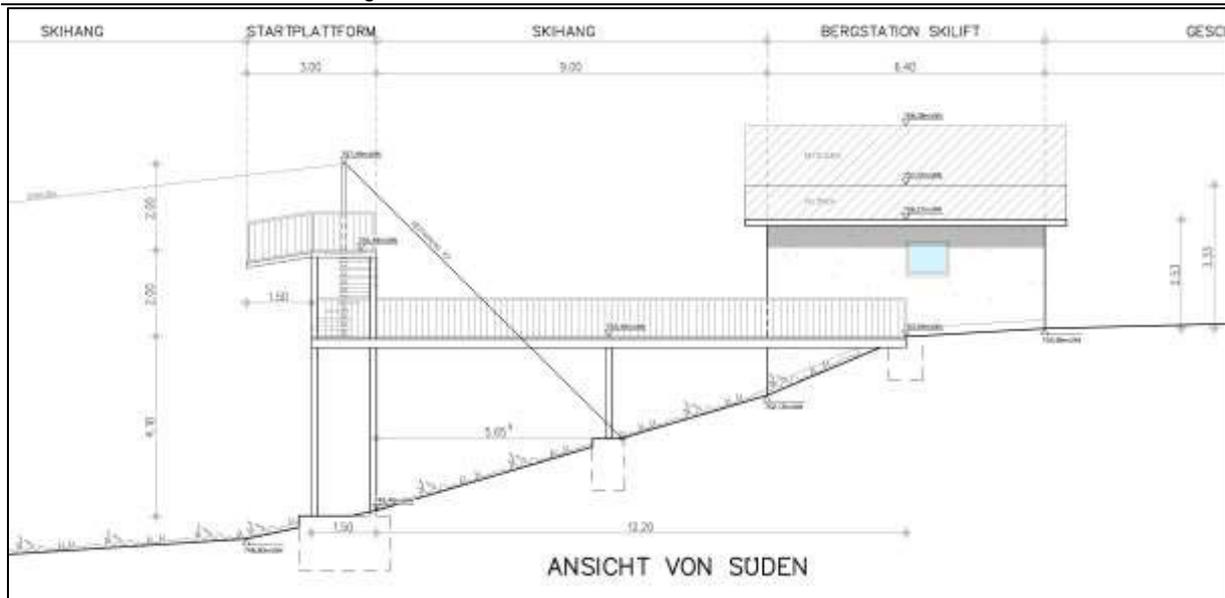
Ansicht der geplanten Startplattform mit Zugang und vorhandener Bergstation (Entwurf)
